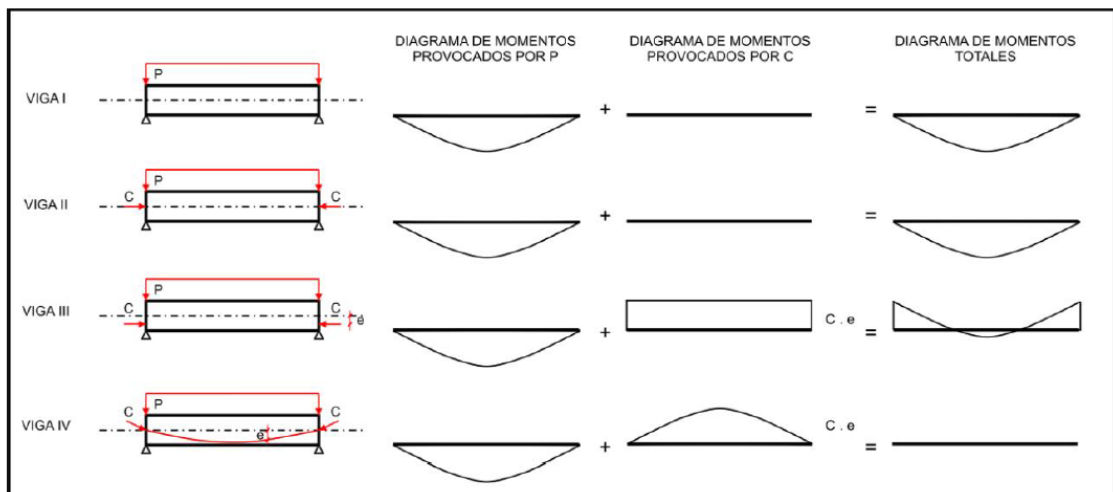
Diagramas de momento en hormigón armado y pretensado.
